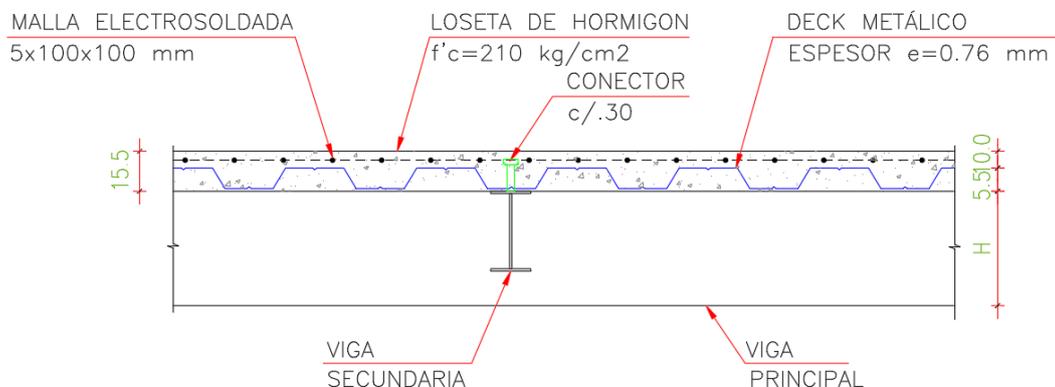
Sistema de Entrepiso (Losa Deck Metálico)
